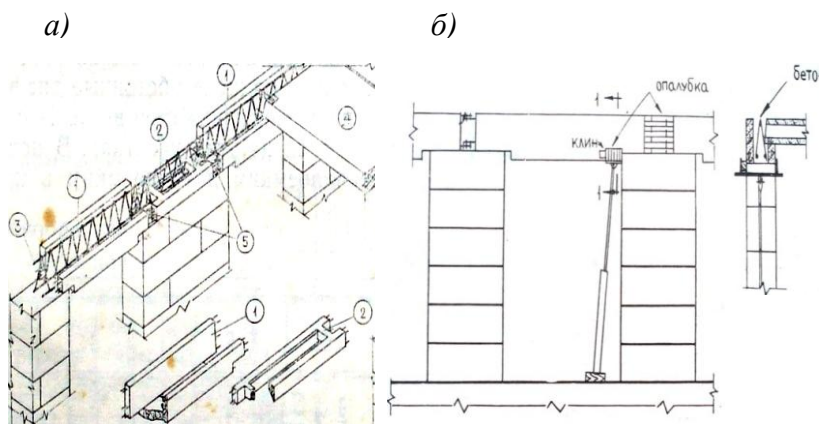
Конструкция СбМт ригелей в проектах зданий ГПИ «Молдгипрострой» и ОИСИ (а) и устройство опалубки (б): 1 – сборный перемычный блок с днищем над проемом; 2 – рядовой блок, без днища над стеной; 3 – арматурные каркасы монолитной обвязки; 4 – панель перекрытия; 5 – стык сборных блоков [63, с. 289].
